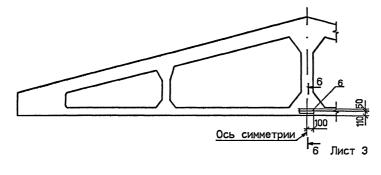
Для крепления связей к крайним фермам в покрытии с железобетонными плитами при сейсмических нагрузках
